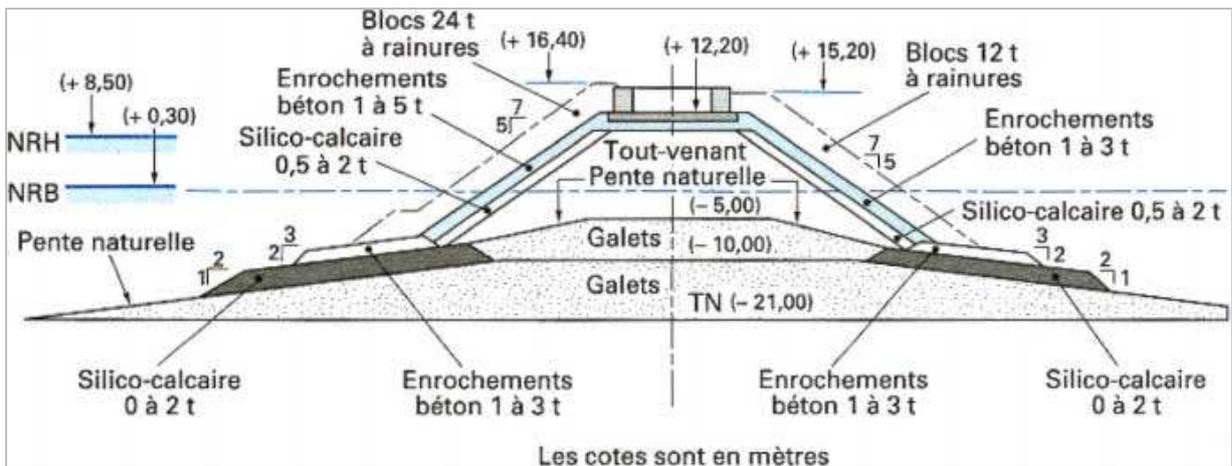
Port du Havre-Antifer : coupe type de la digue.
